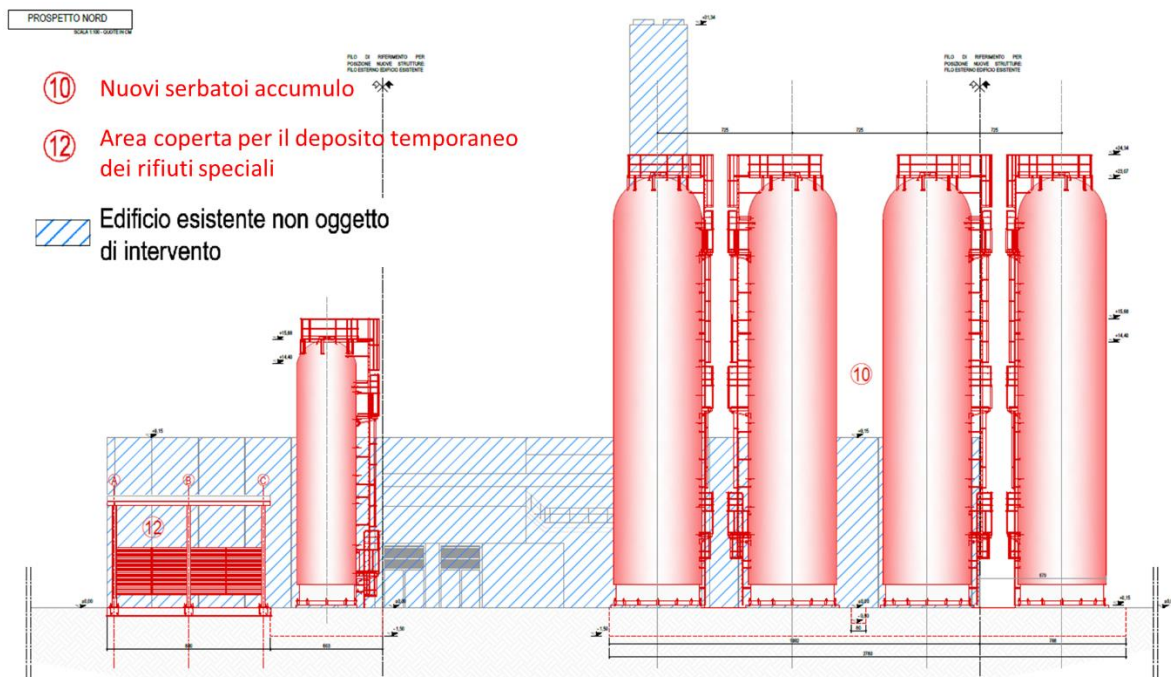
Nuovo Sistema di Accumulo, Prospetto Nord (in blu gli edifici esistenti non oggetto di intervento)
